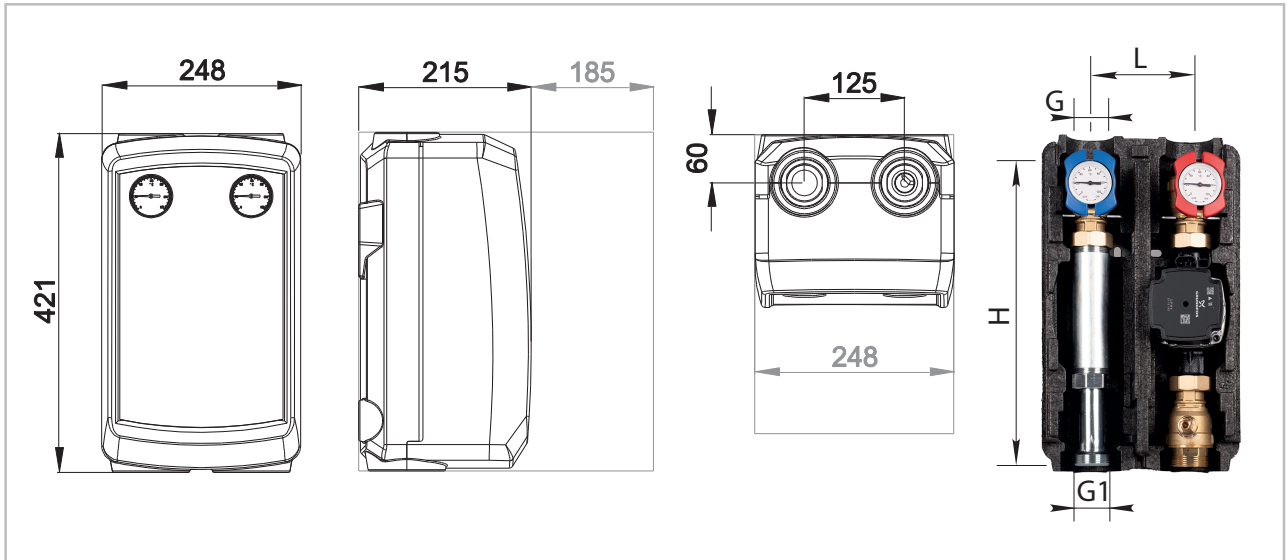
Geräteabmessungen Pumpengruppe HGU (alle Angaben in mm)
